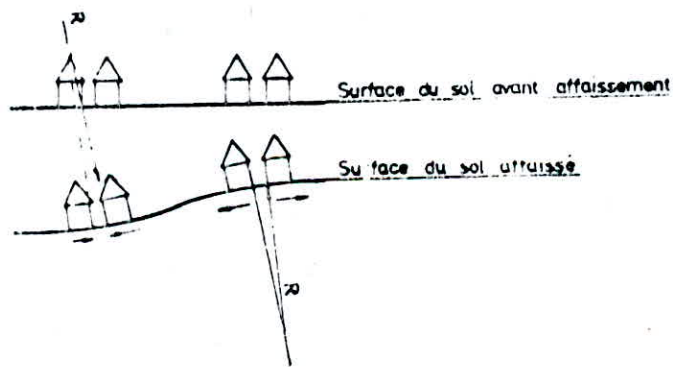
Zones d'extension et de compression dans la cuvette d'affaissement.
